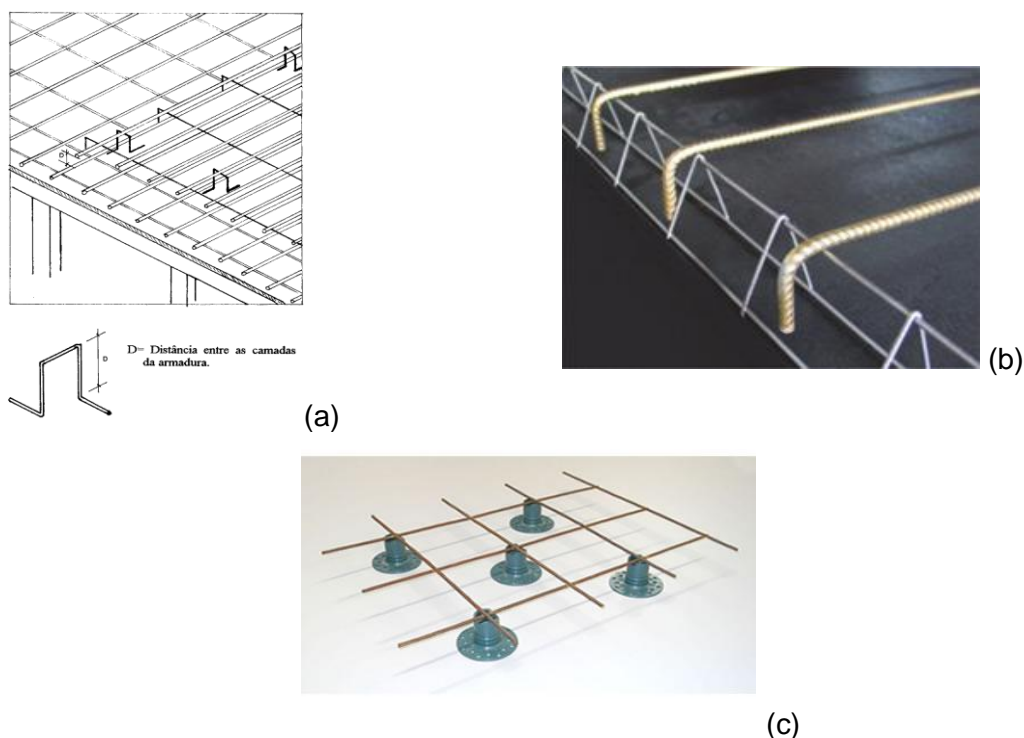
Espaçadores: Metálico – caranguejo (a); Metálico – treliça (b) e Plástico (c)
